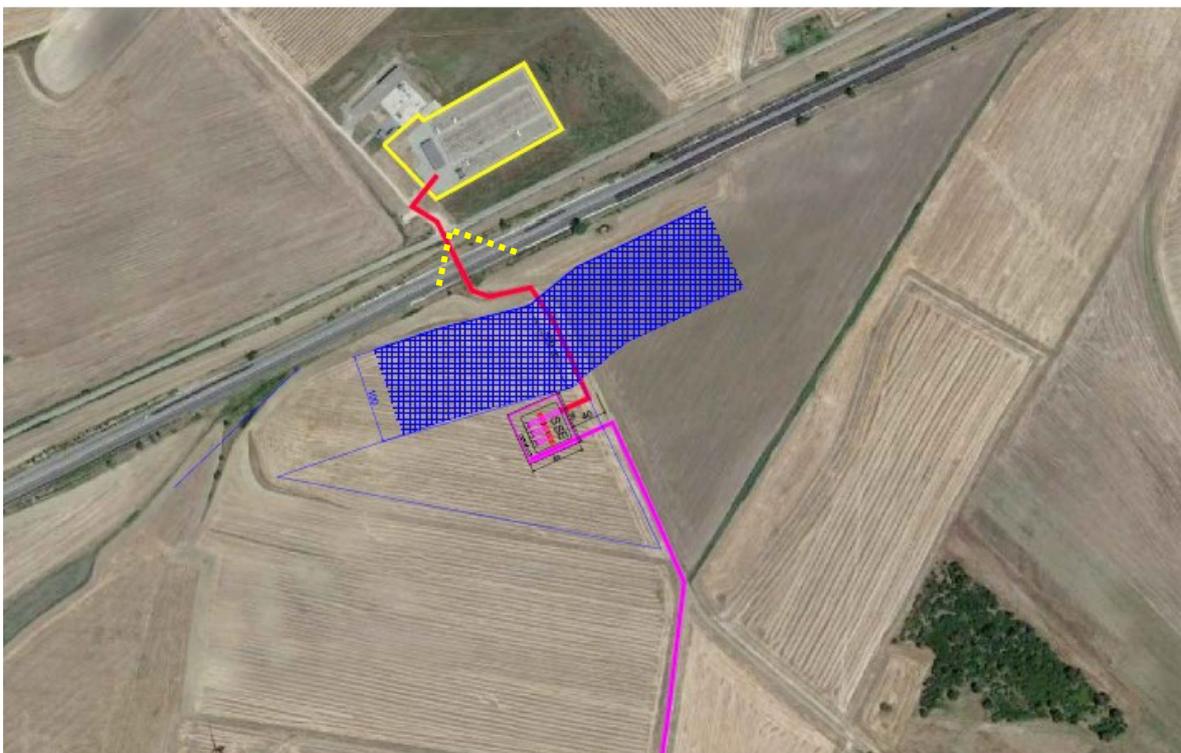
Layout di impianto dell'Area della Sottostazione Utente
